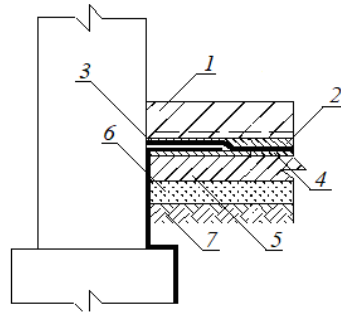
Сочетание фрагментированного барьера с мембраной: 1 — монолитный, армированный дорожной сеткой бетон; 2 — защитный слой; 3 — рулонный гидроизоляционный материал; 4 — выравнивающая стяжка; 5 — подготовка из тощего бетона; 6 — песчаная подсыпка; 7 — уплотнённый грунт
